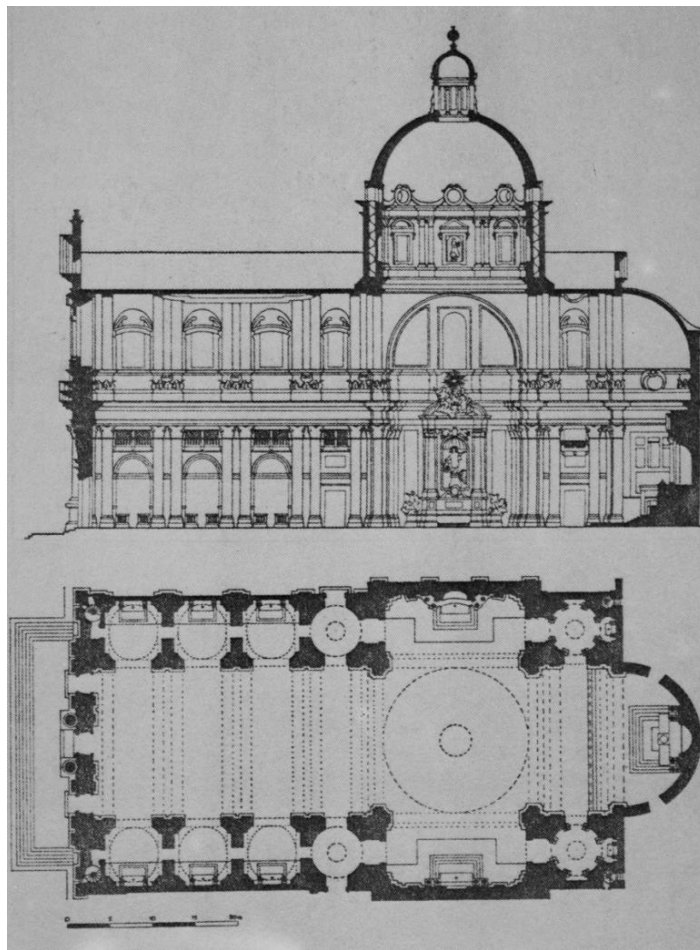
Längsschnitt und Grundriss, Il Gesù, Rom.
